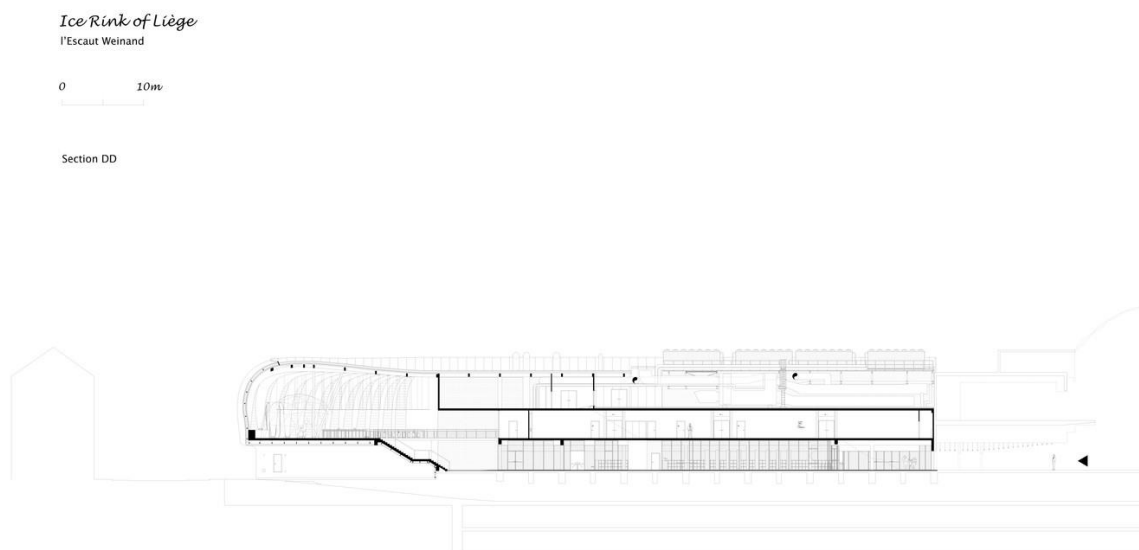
Повздовжній розріз, арх. L'Escaut Architectures + BE Weinand
